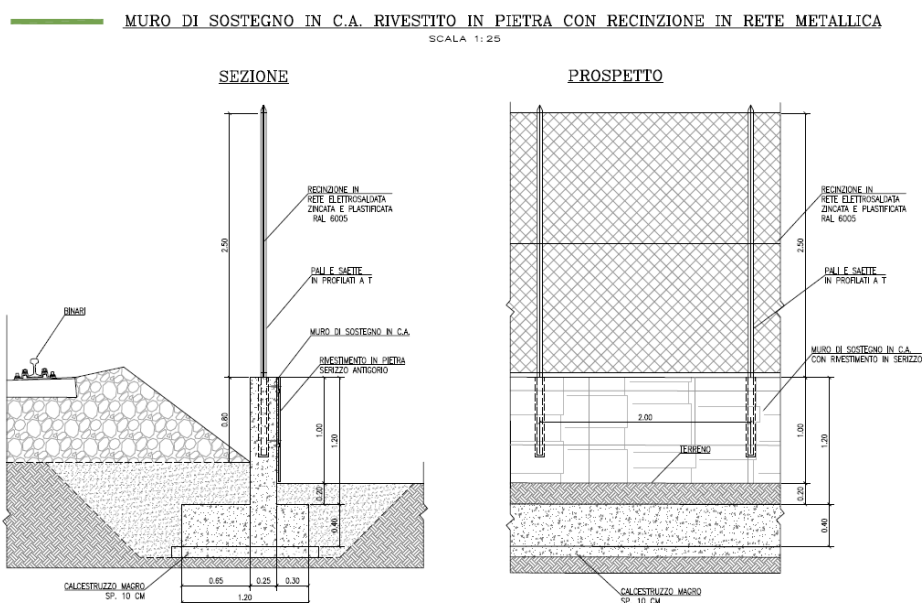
Dettagli recinzione in rete metallica su muro in c.a. rivestito in pietra
